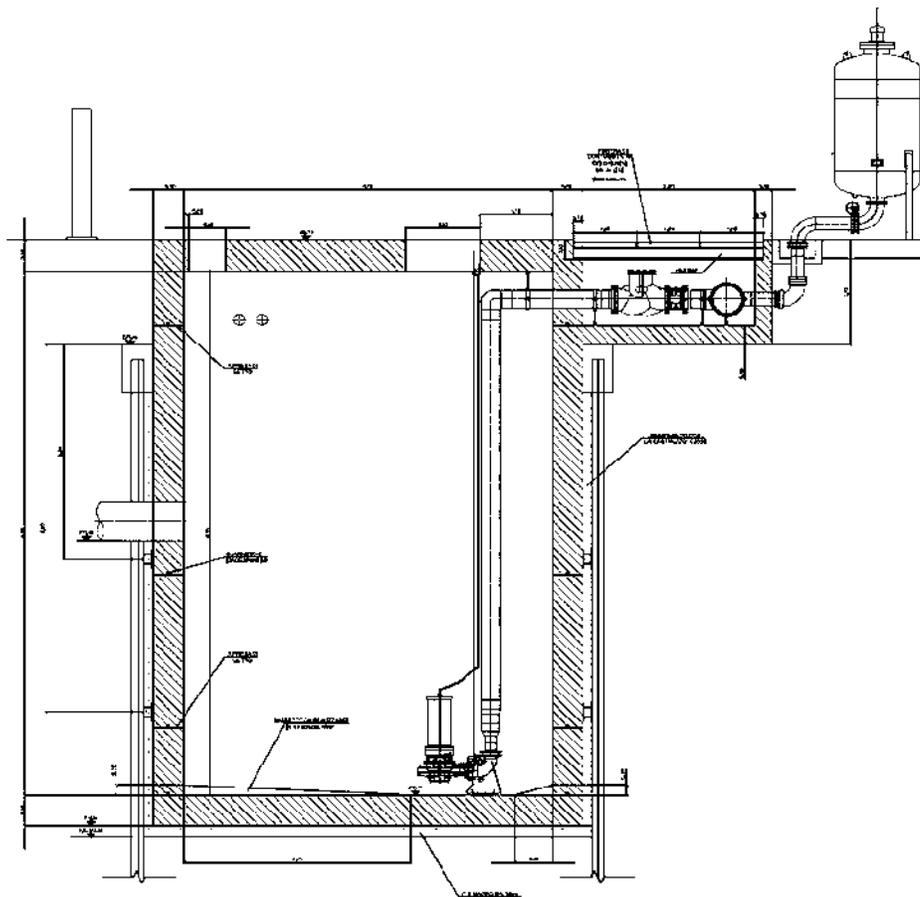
Stazione di sollevamento 1, sezione verticale carpenteria
